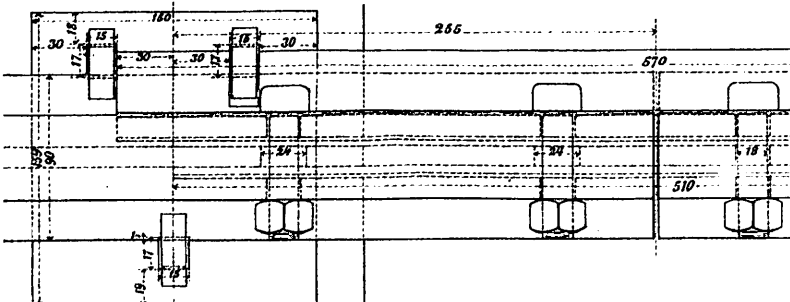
Grundriss des Schienen-Stoßes
